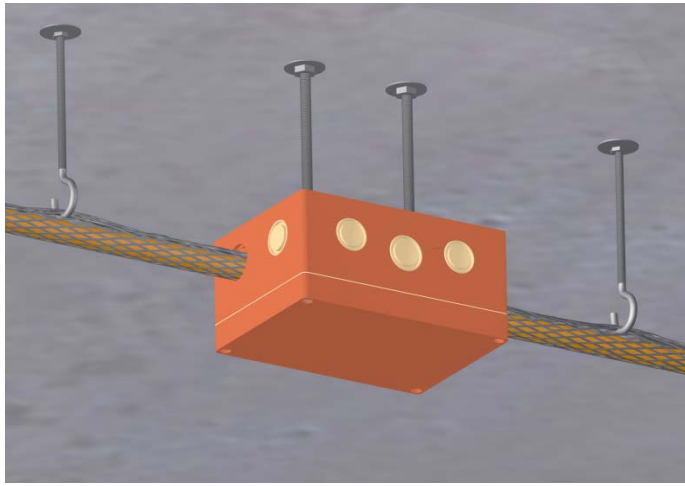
Крепление монтажной пластиковой коробки KSK на шпильки.
